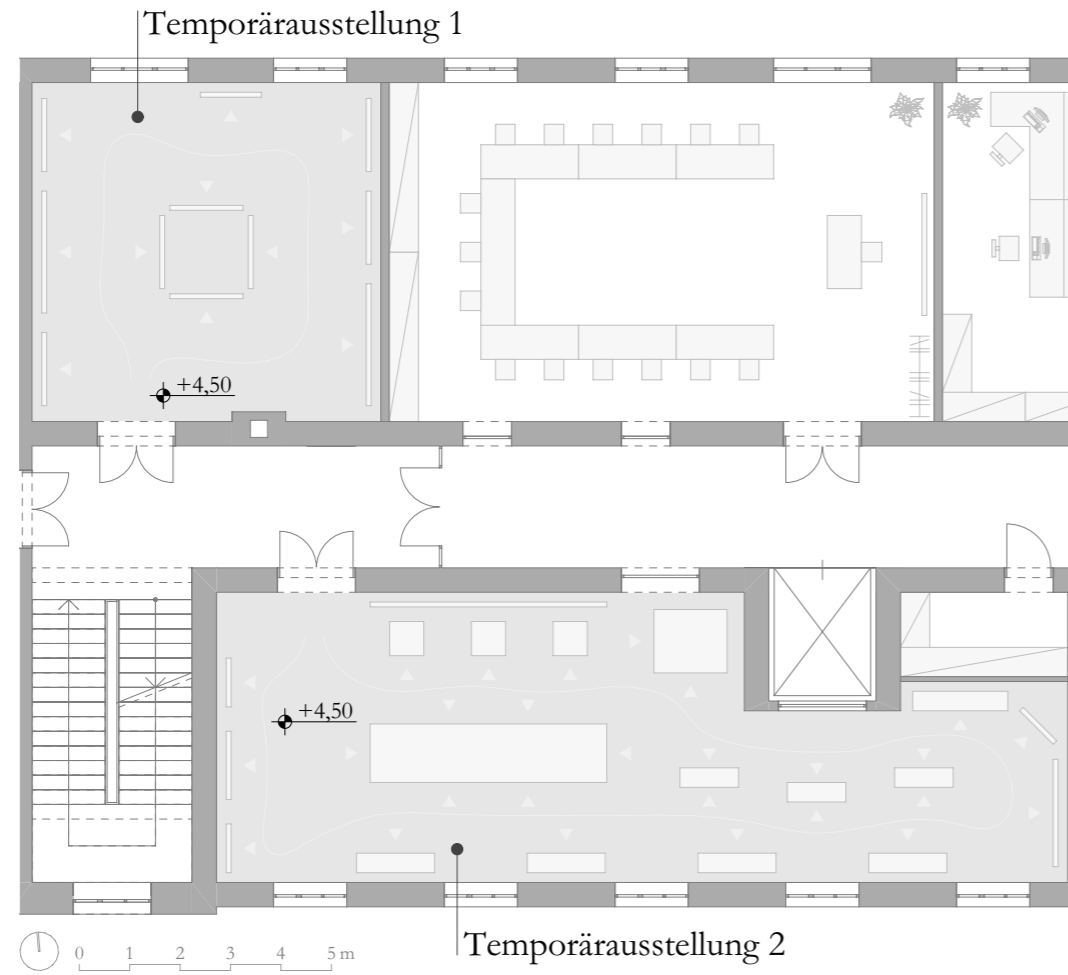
Grundriss Obergeschoss (Detail Temporärausstellungen) M 1:150
